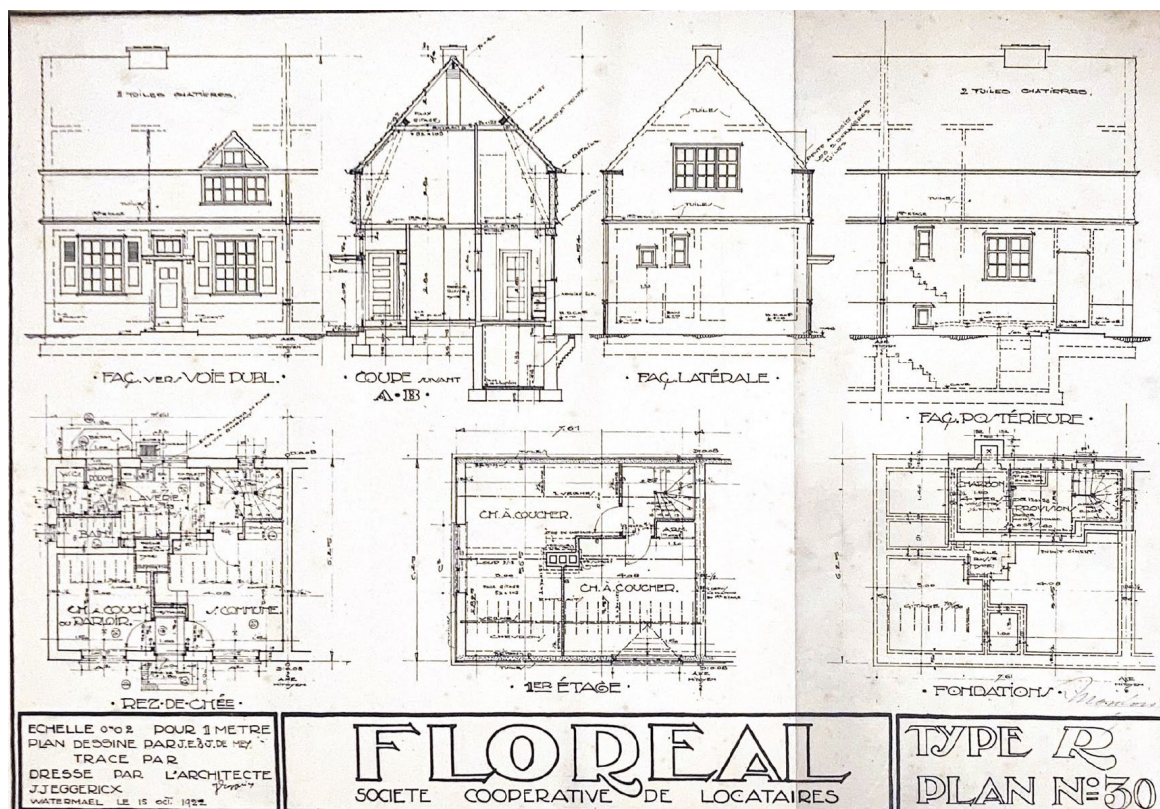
Plans Type R -Floréal J.J Eggericx -Archives Civa
